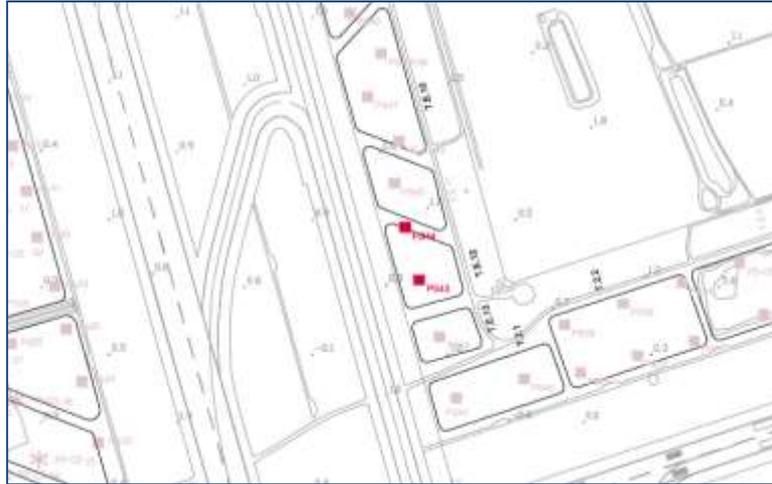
Stralcio planimetrico con l'ubicazione dei punti di indagine nelle aree di riutilizzo per il rimodellamento del terrapieno T.E.12
